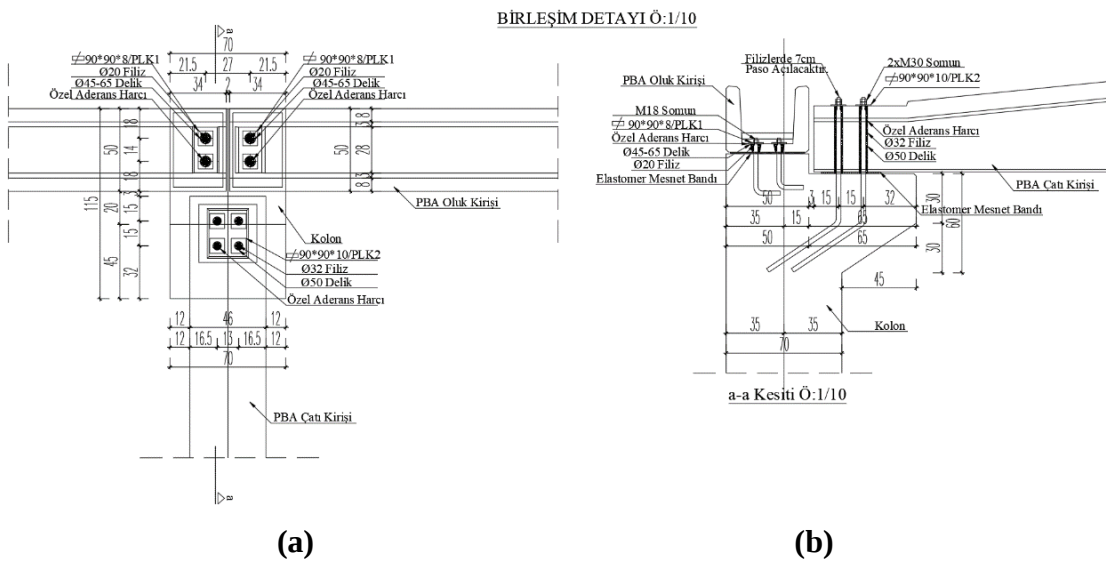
(a,b) Prefabrike betonarme binanın yerinde yapılan incelemeler sonucunda tek pimli bağlantı detayı.
